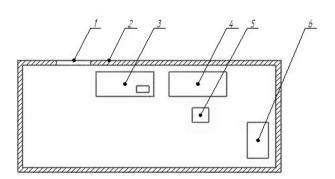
Внутреннее устройство контейнера для проведения сварочных работ (1 — входная дверь; 2 — стенка контейнера; 3 — стол для проведения сварочных работ; 4 — рабочий стол; 5 — стул; 6 — место хранения сварочного оборудования)
